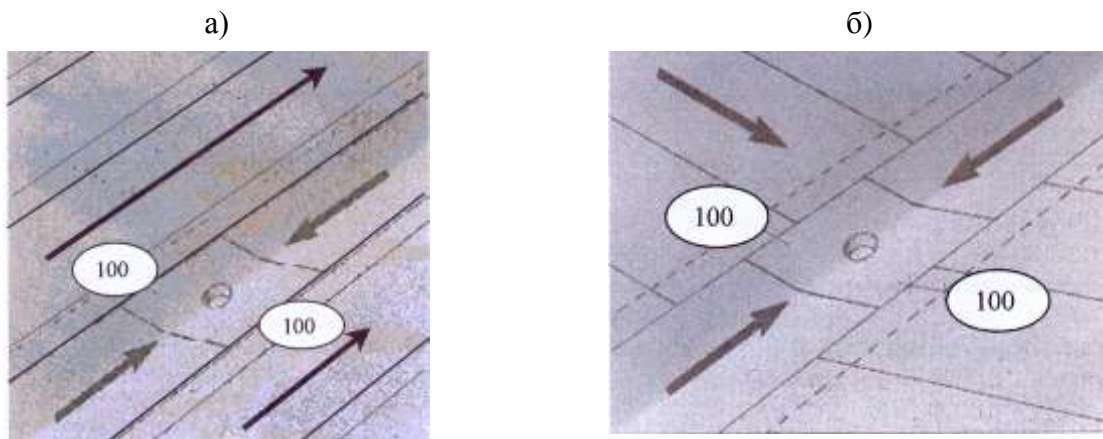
Направление раскладки рулонного материала на кровле с уклоном 15 % и менее (а) и на кровлях с большими уклонами (б).
